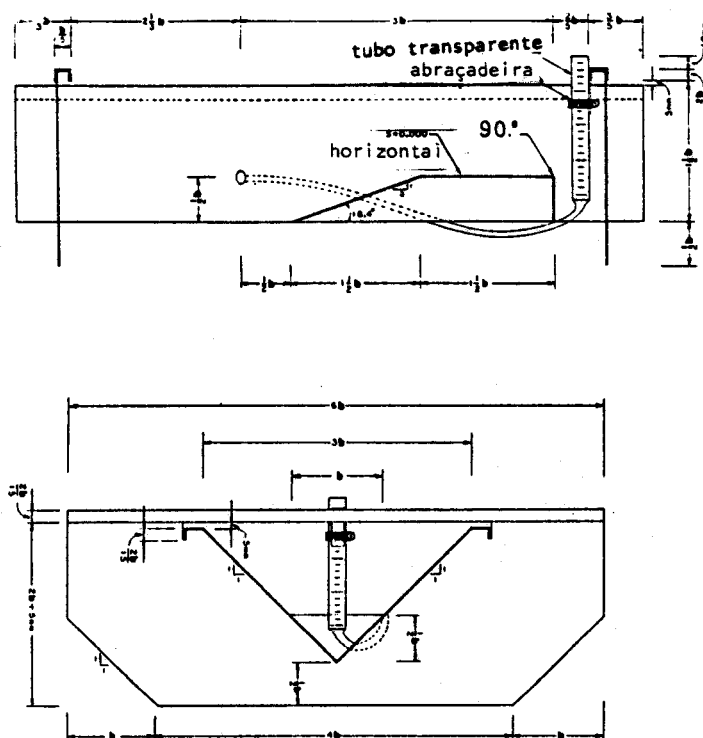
Plano de um descarregador-medidor de Replogle e Bos (1982). Em cima corte longitudinal; em baixo vista de frente.
